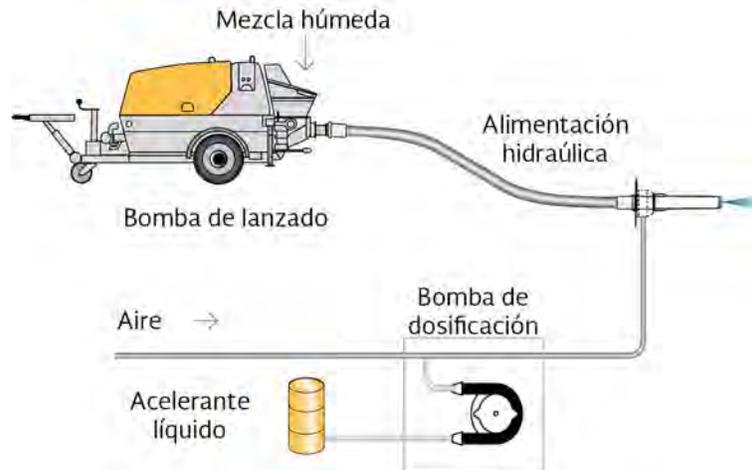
Equipo de lanzado por vía húmeda. Tomado de Putzmeister (2011).
